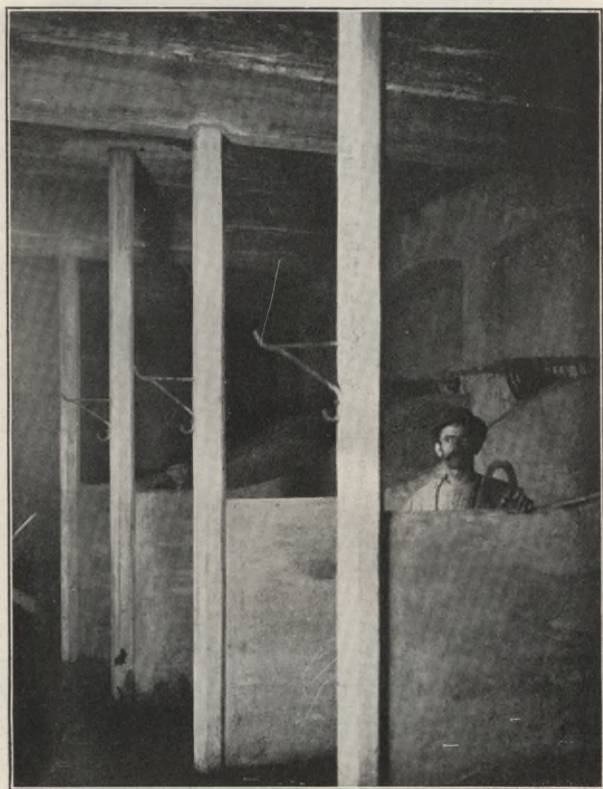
Trennwände aus Eisenbeton in einem Pferdestall.
